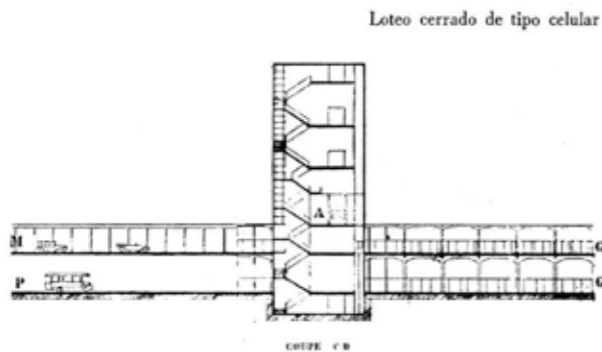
Corte longitudinal por el eje de la calle y la escalera principal.
